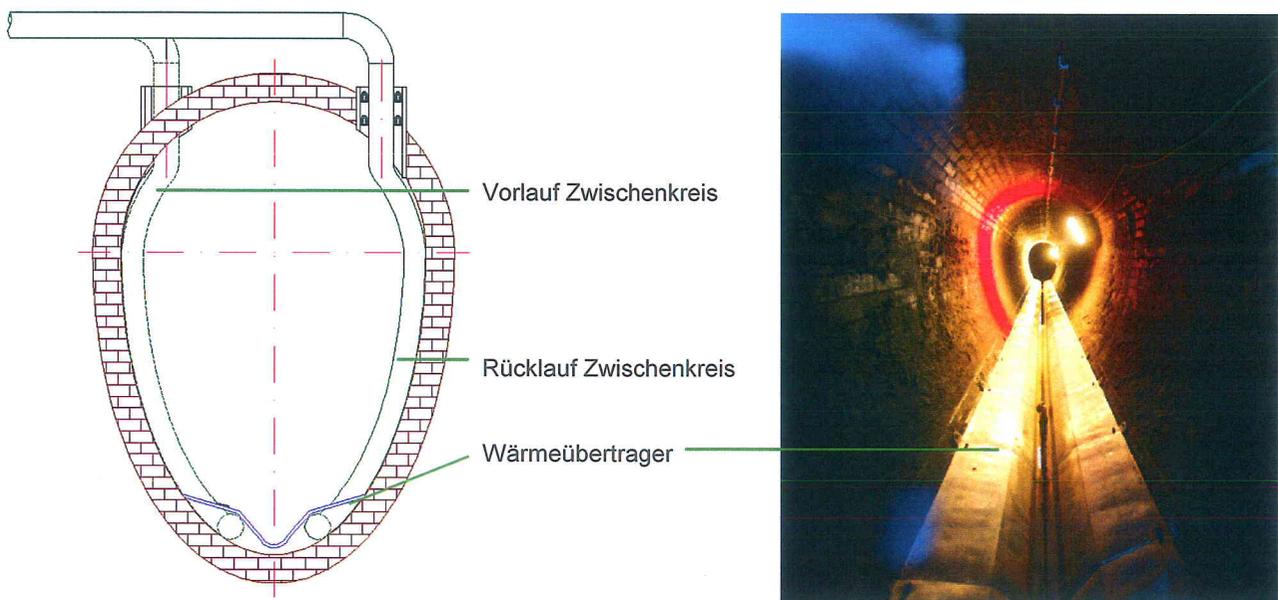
Schema und Foto Kanal mit Abwasserwärmeübertrager einer realisierten Anlage (Berlin)
